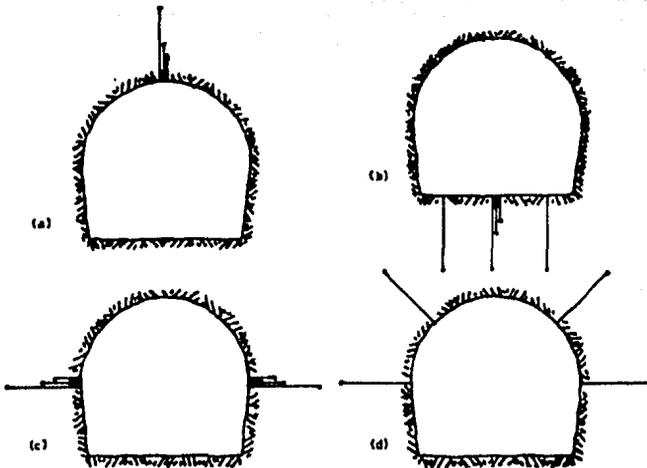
Arreglos de Extensómetros longitudinales instalados dentro del túnel
